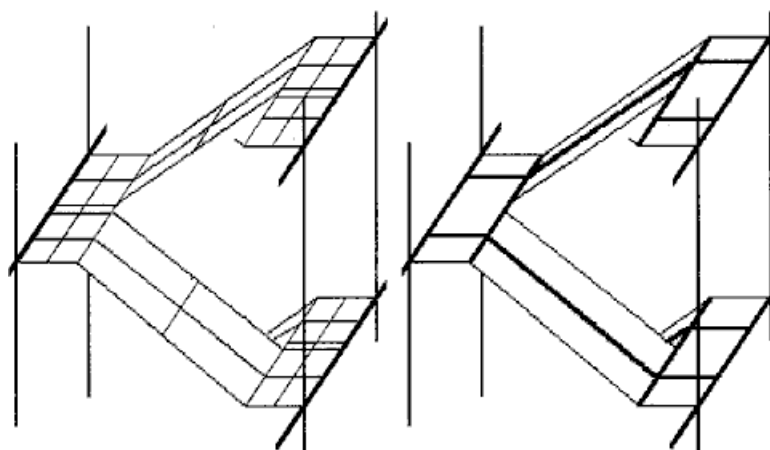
Modellazioni di solette rampanti mediante elementi lastra-piastra ed elementi trave
